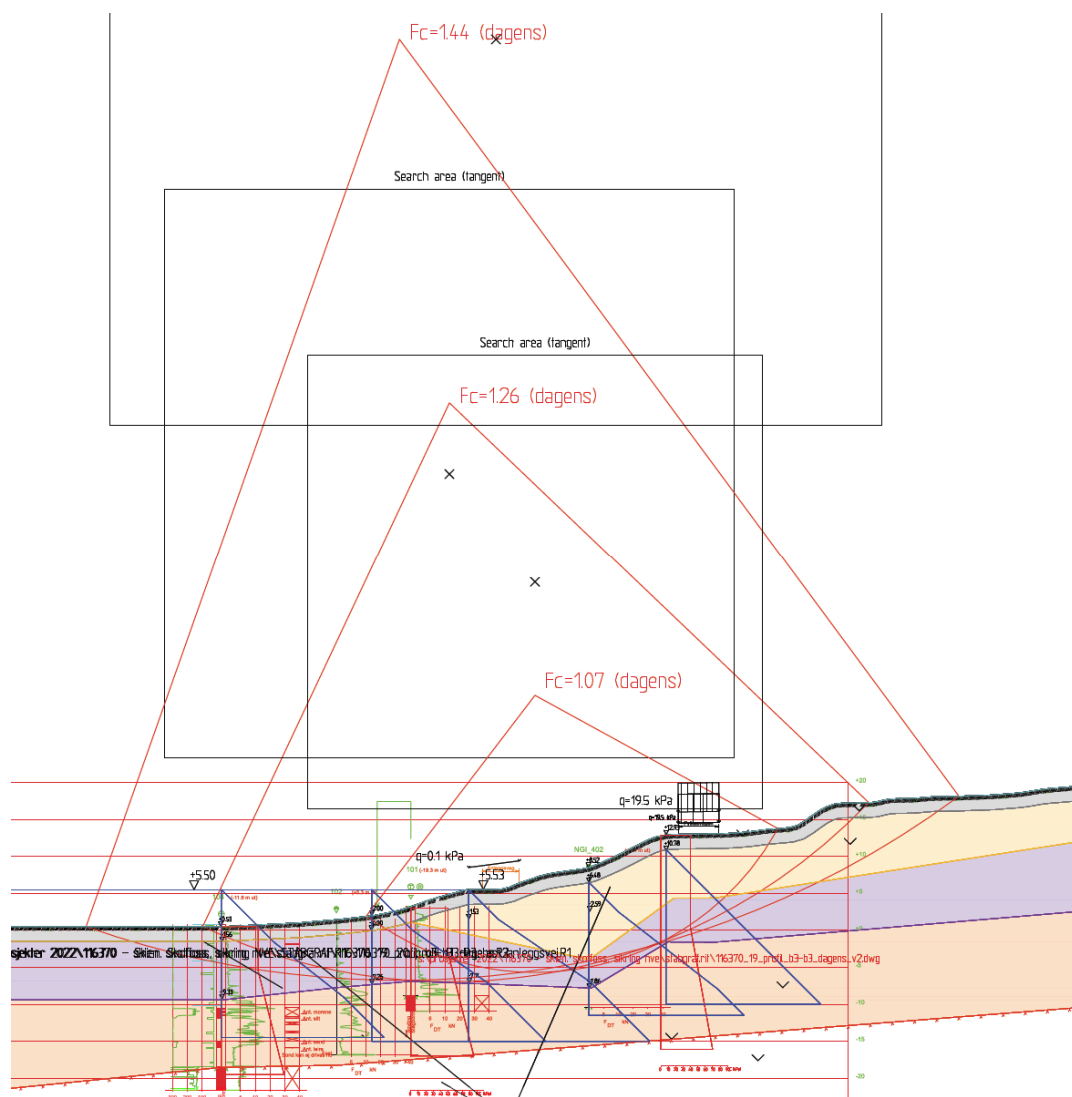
Utsnitt av beregning nr. 6 [5], dagens situasjon profil A-A, totalspenningsanalyse.
